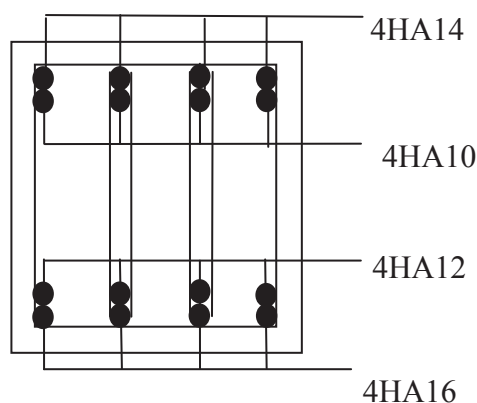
Schéma de ferrailage de la poutre palière de l'escalier type I
